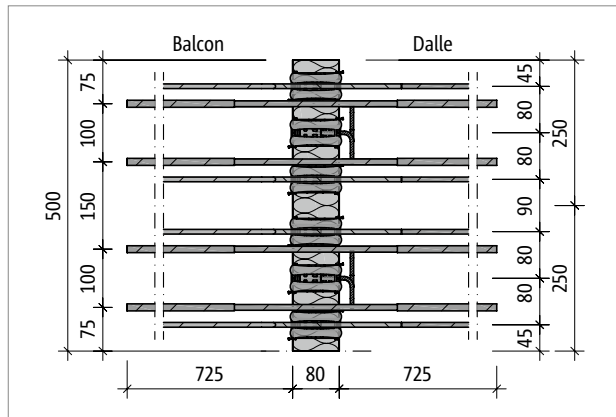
Schöck Isokorb® T Type K-E-M6 : Plan de base du produit de la variante L500
